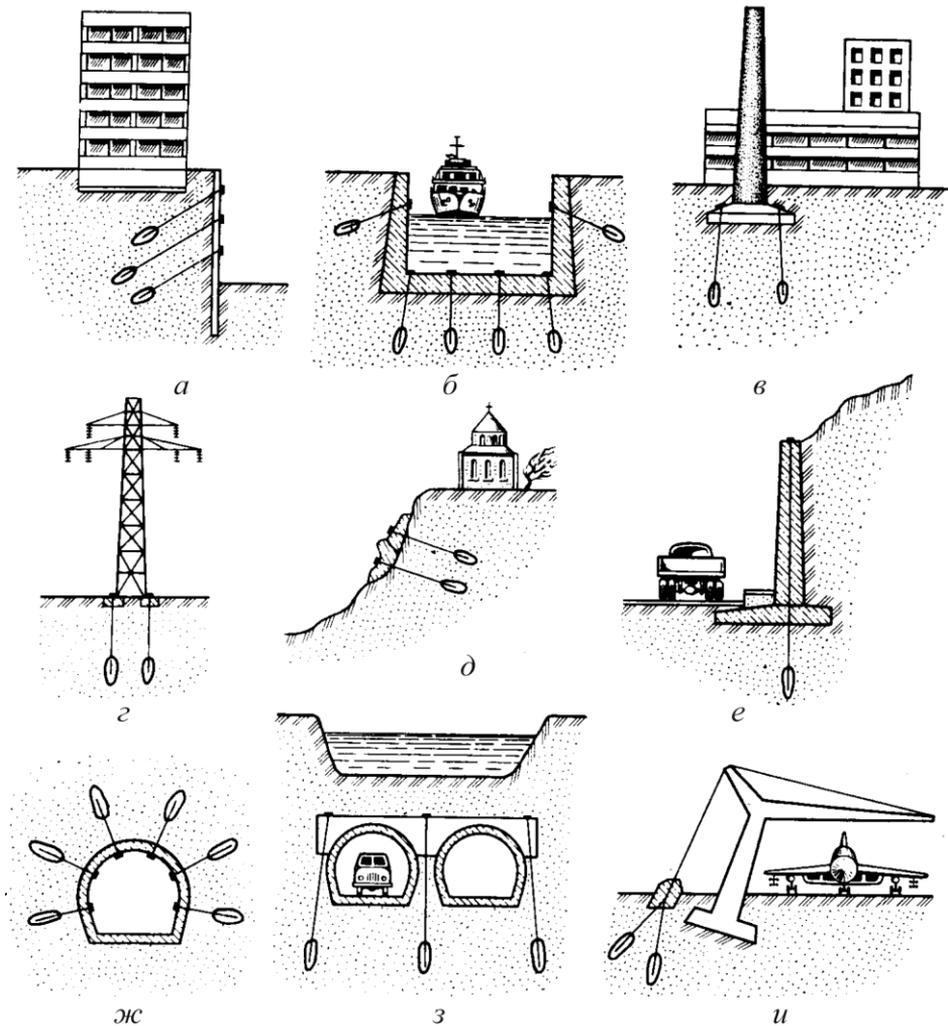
Применение анкерных устройств: *а* – крепление котлована; *б* – крепление днища и стенок дока или шлюза; *в, г* – восприятие выдергивающих сил в фундаментах дымовых труб и мачт ЛЭП; *д* – крепление откоса; *е* – усиление подпорной стенки; *ж* – крепление свода подземного перехода; *з* – противодействие взвешивающему давлению грунтовой воды на тоннели; *и* – восприятие опрокидывающего момента от перекрытия ангара
